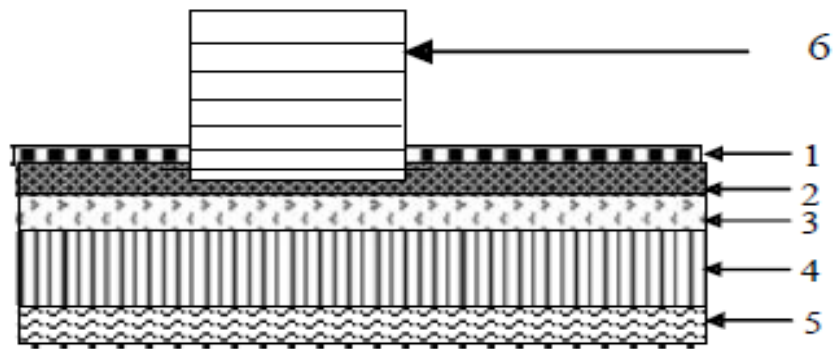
Coupe verticale d'un plancher étage courant - corps creux-
